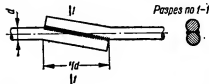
Стык стержней внахлестку, выполненный дуговой сваркой при двустороннем фланговом шве.
